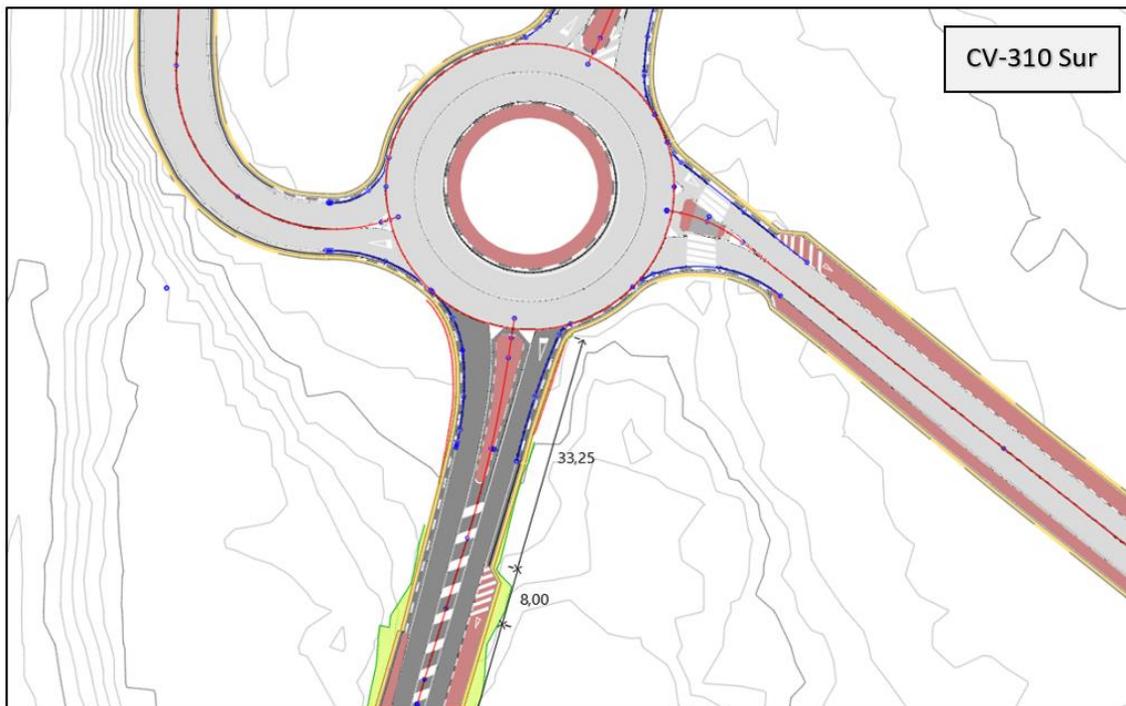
Detalle de glorieta - Mejora propuesta CV-310 (Acceso Sur)
